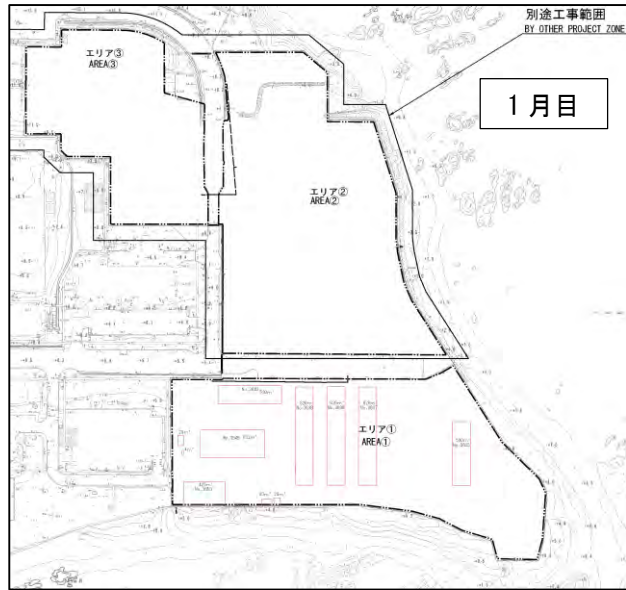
(1) 赤土等流出対策工事平面図 (I工区)
